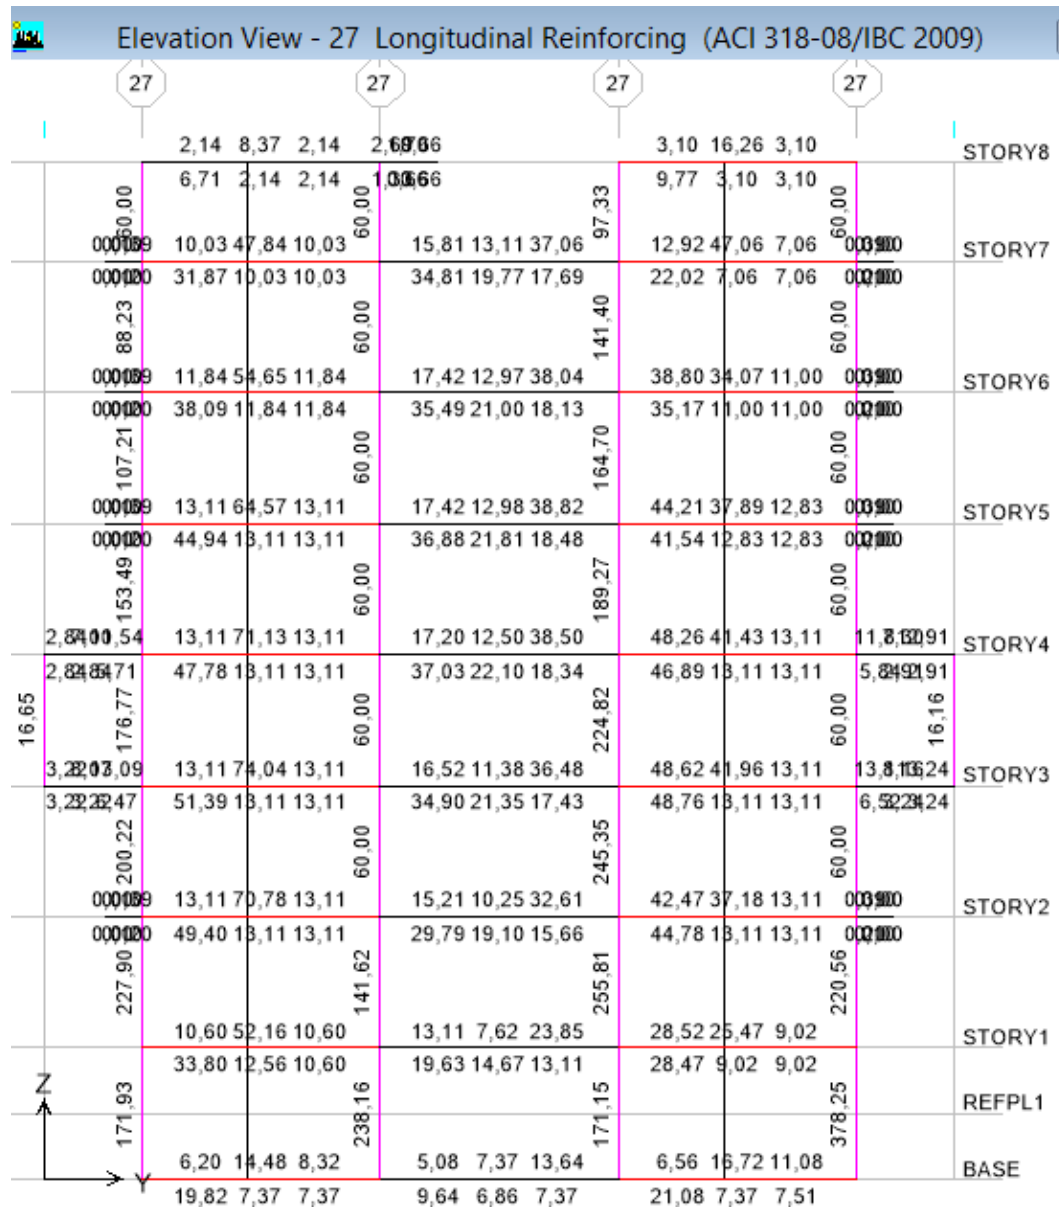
Acero en Vigas y Columnas en el Pórtico 27 – Hospitalización 2- (LRB+HDR)
